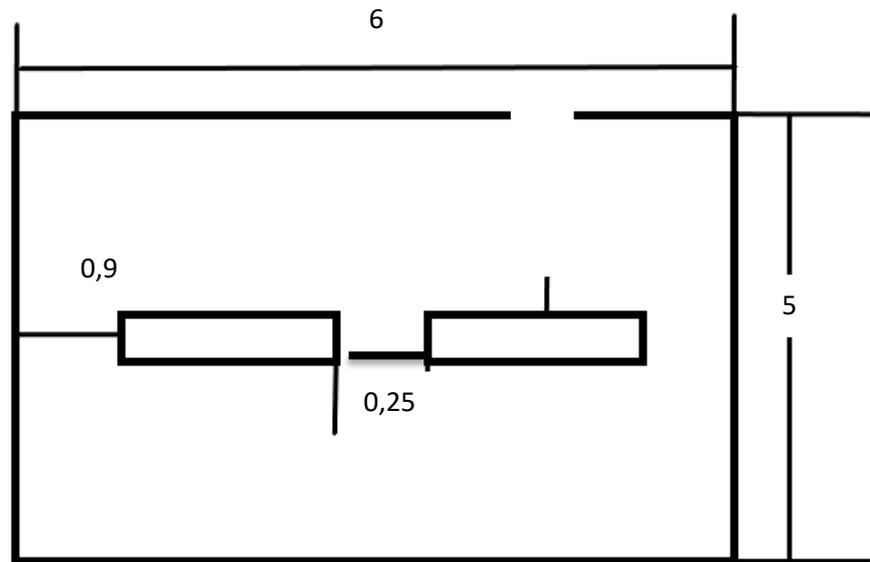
План и размещение светильников с люминесцентными лампами
